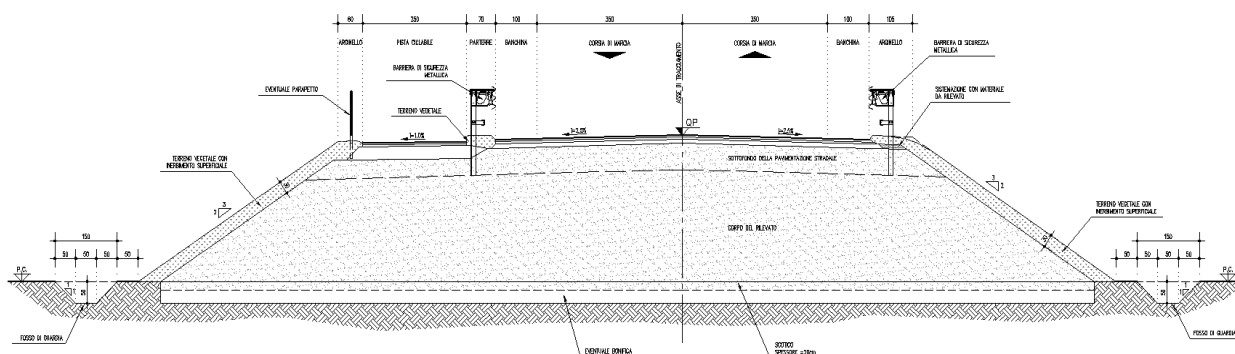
DEFINIZIONE ILLUSTRATIVA DEGLI ELEMENTI COMPONENTI LO SPAZIO STRADALE
